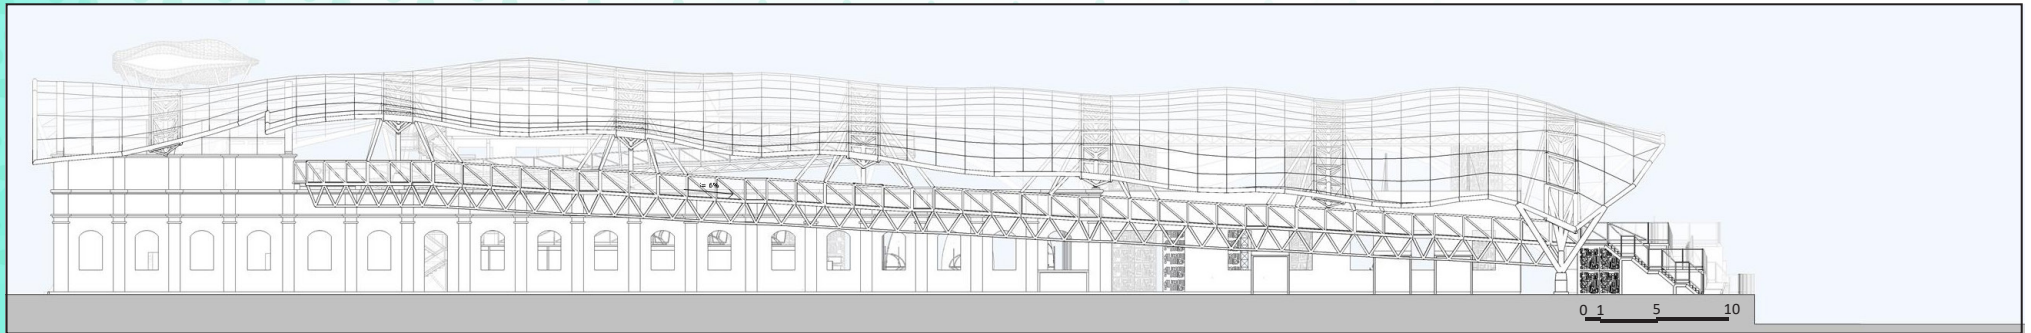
Elevação Nordeste. Planta técnica anexa em escala 1:200. Rafael Rodamilans, 2018
